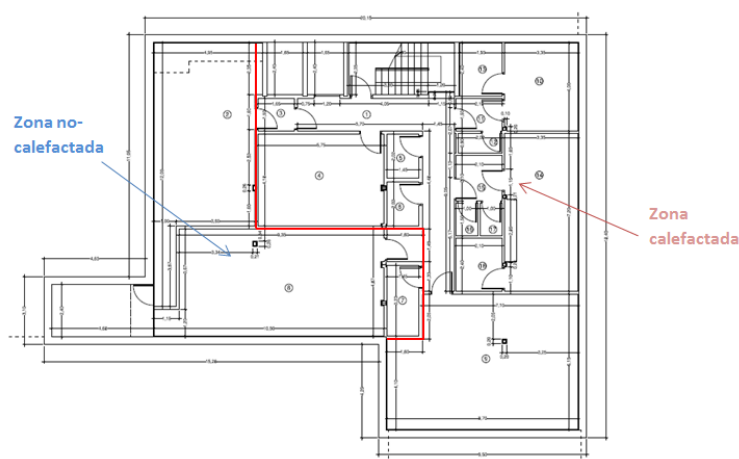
vista en planta de las dos zonas térmicas definidas para el sótano.
